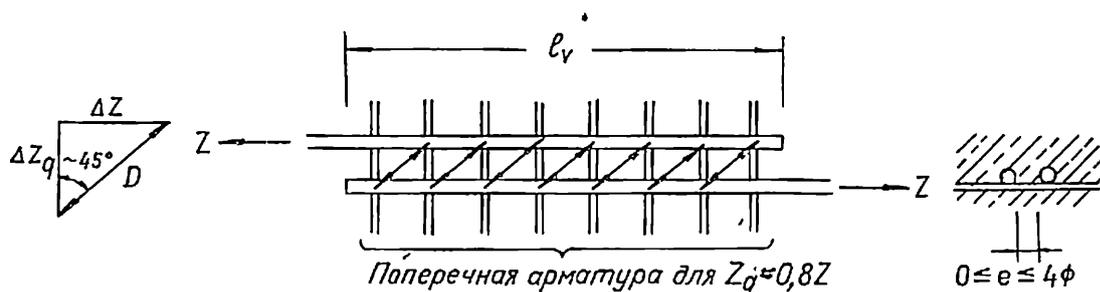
I. Передача усилий в стыковых соединениях внахлестку
